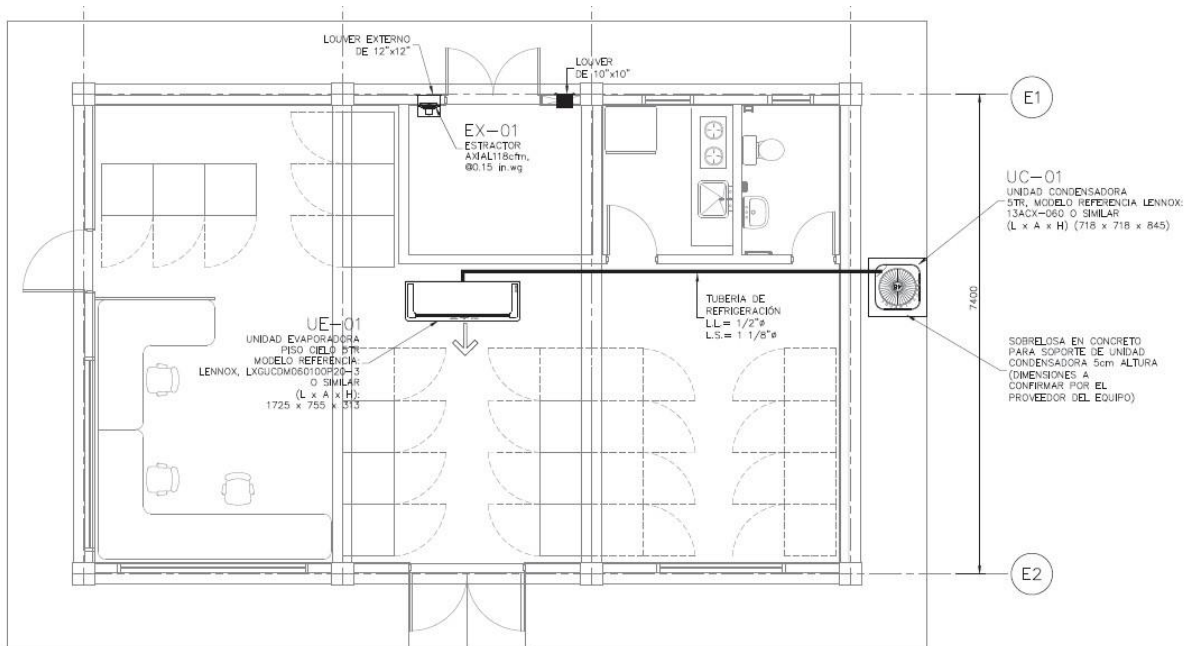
Planta sistema de aire acondicionado Edificio de control tipo las referencias son indicativas y deberán ser justificadas con el diseño de detalle. (El detalle de distribución se adjunta en plano prototipo para la SE CHIANTLA)
